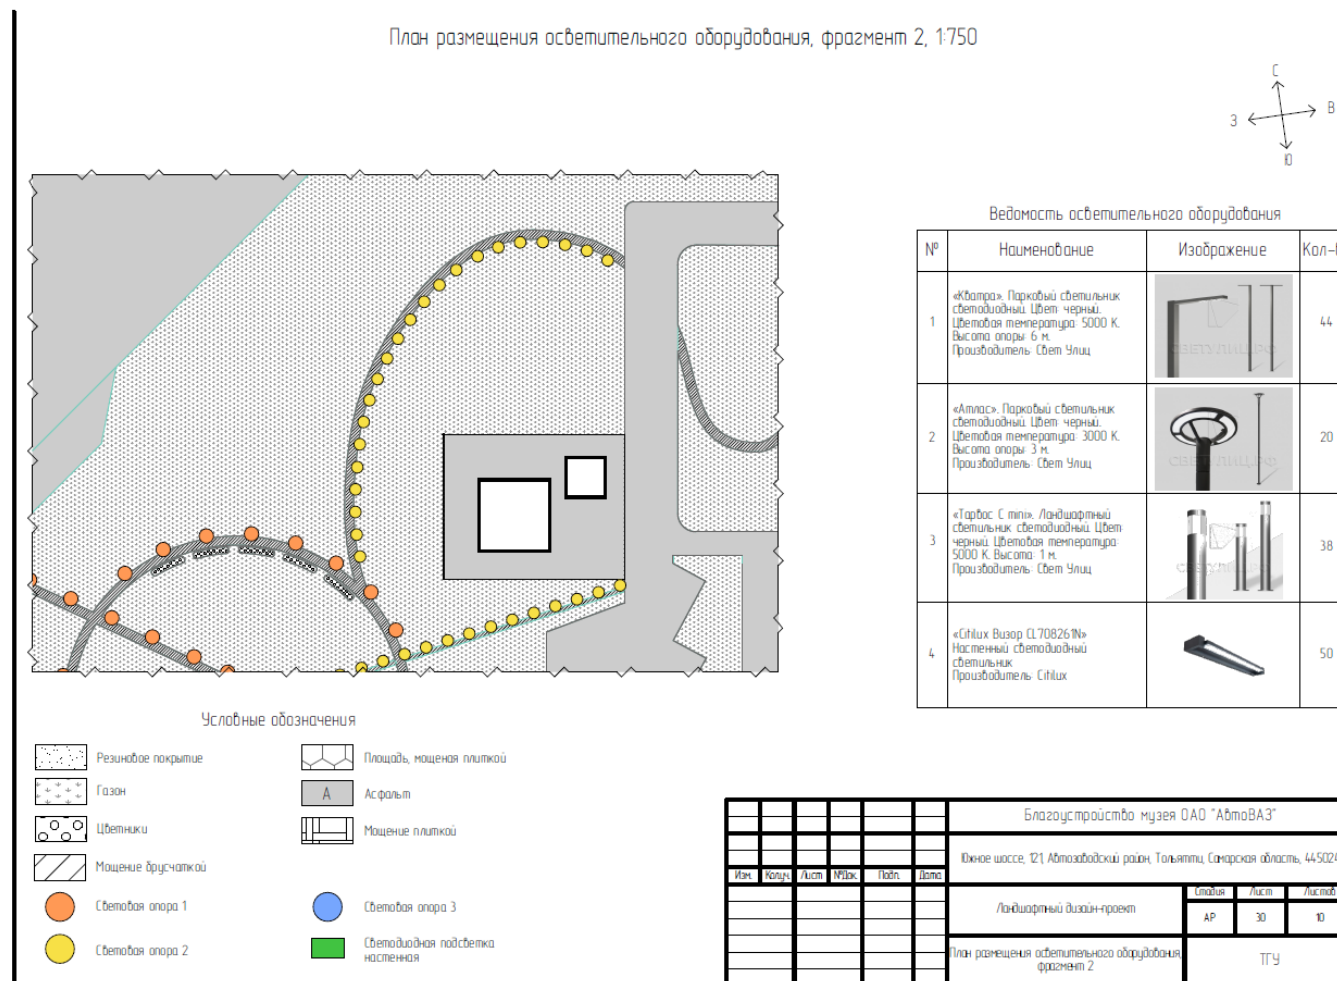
Схема плана размещения осветительного оборудования, фрагмент 2
